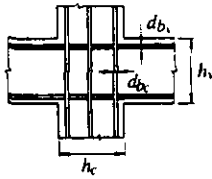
Anclaje de refuerzo longitudinal en vigas extremas de marcos dúctiles
